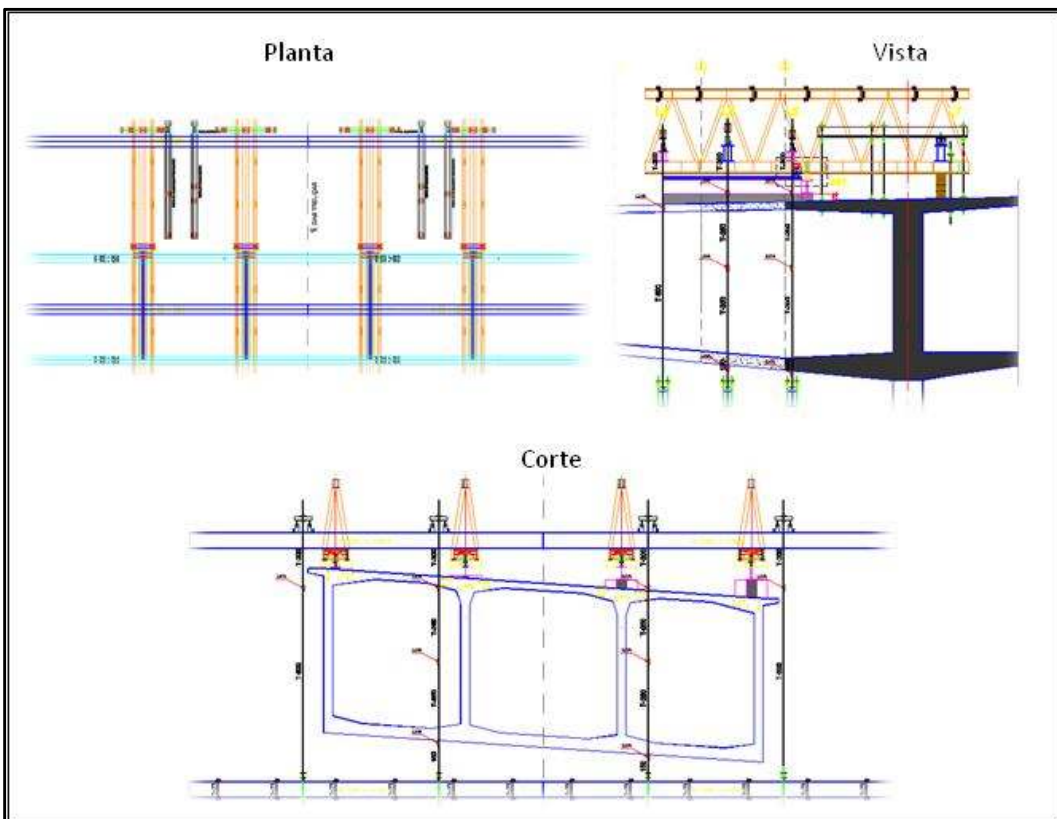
Esquema de planta, vista e corte referente ao Balanço Sucessivo com treliça lançadeira e aduelas moldadas no local da obra do Rodoanel – OAE 517 – PE - (Aspem) - Embú/SP – Construtora OAS
